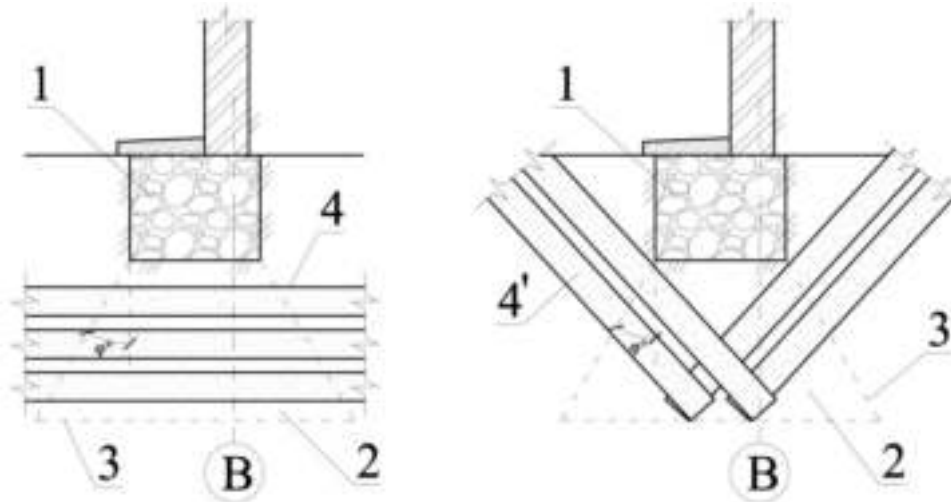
Схема для визначення об'ємів армування ґрунтів основ фундаментів: а) при горизонтальному армуванні; б) при похилому армуванні; 1 – фундамент; 2 – зона активних деформацій; 3 – лінія умовного фундаменту; 4 – горизонтальні ґрунтоцементні елементи; 4' - похилі ґрунтоцементні елементи
